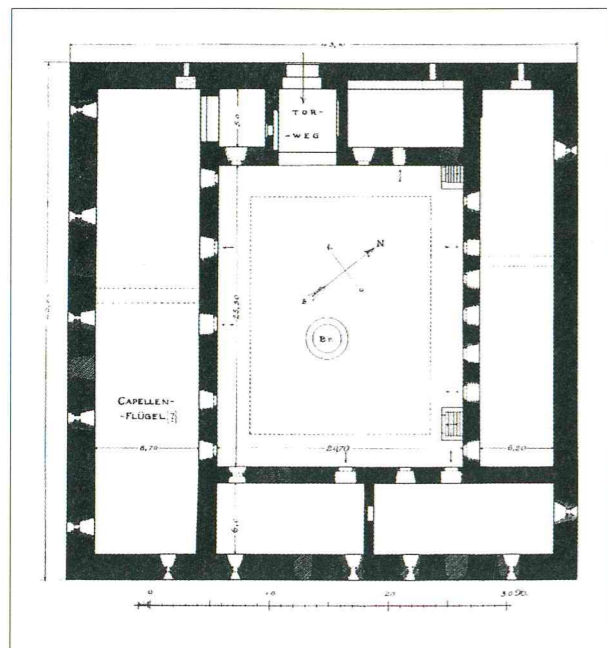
Insterburg. Grundriss der Deutschordensburg (nach Steinbrecht)
